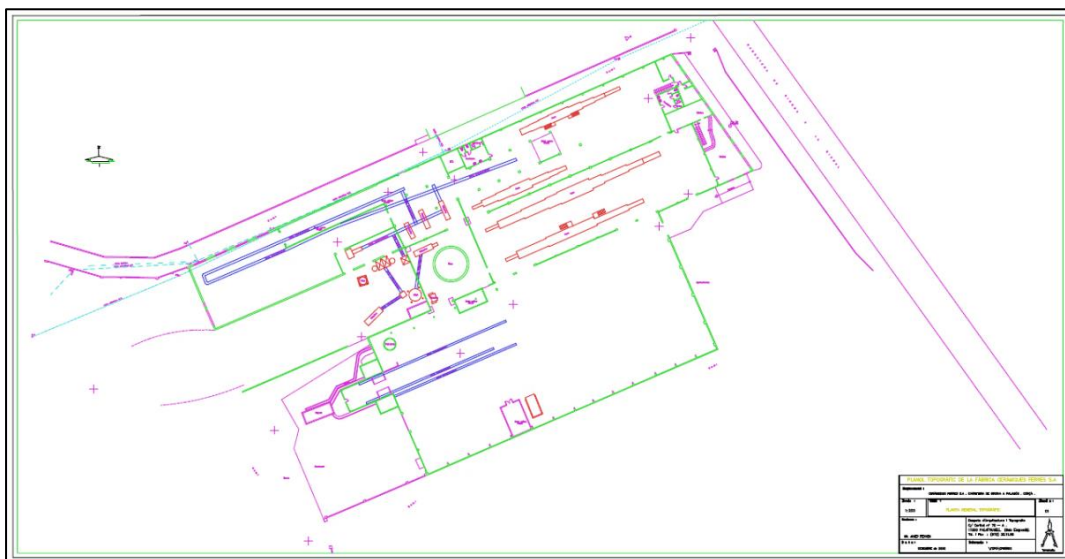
Plano en planta de la zona de producción de la fábrica (Fuente: departamento técnico Cerámica Ferrés)
